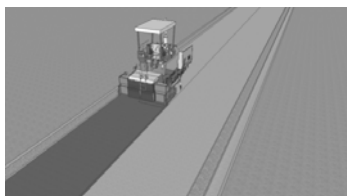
Укладка асфальтобетонной смеси отдельными полосами покрытия одним асфальтоукладчиком
